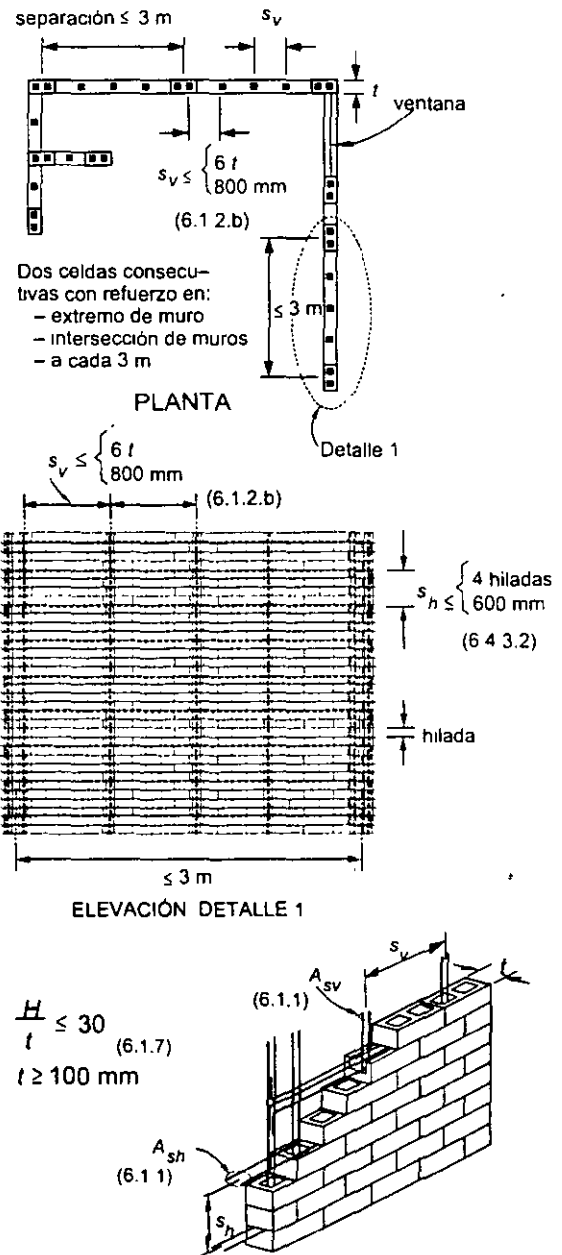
Requisitos para mampostería con refuerzo interior
